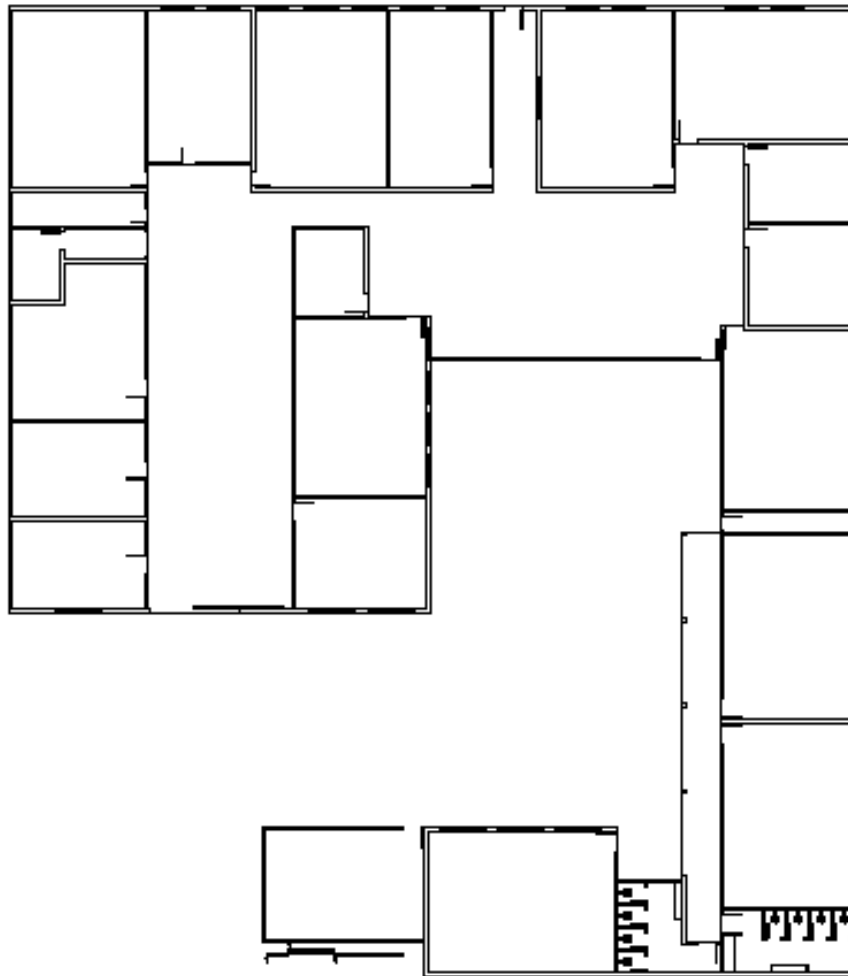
Planta Baixa Escola Municipal Pedro Alexandre Broto
